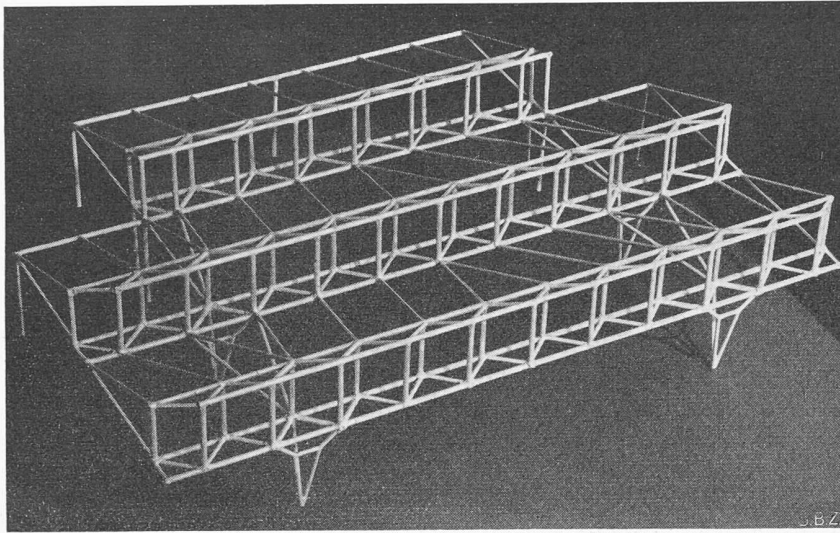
Modell eines Teils des Fabrikdaches mit räumlichen Shedträgern auf je zwei Dreibeinen
